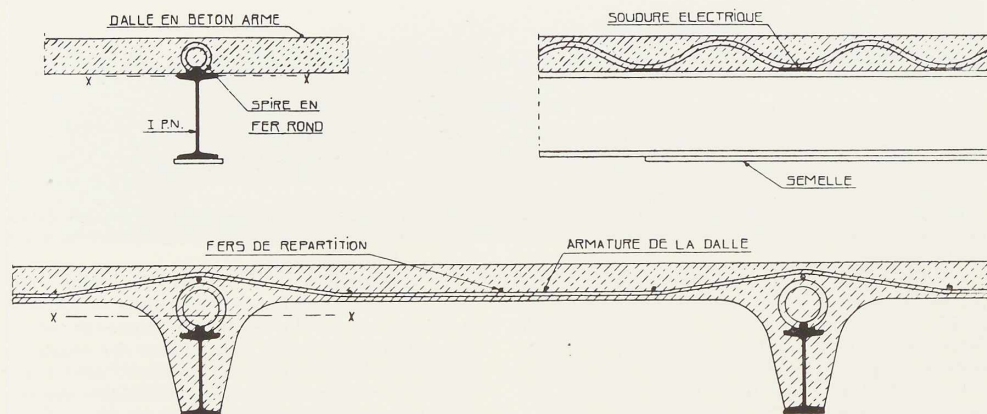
Vue en élévation et coupe transversale d'un hourdis système « Alpha ».
